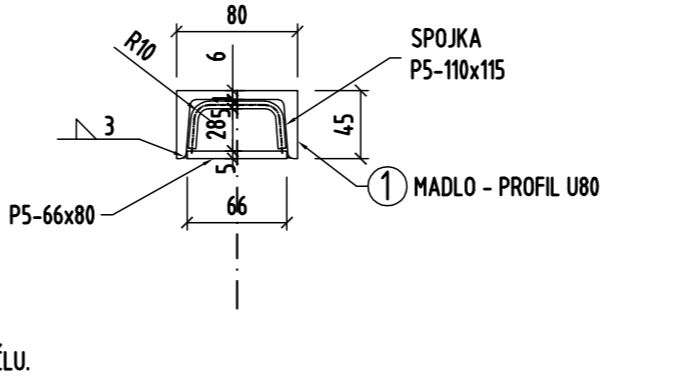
DETAIL STYKU MADLA ZÁBRADLIA 1:5
